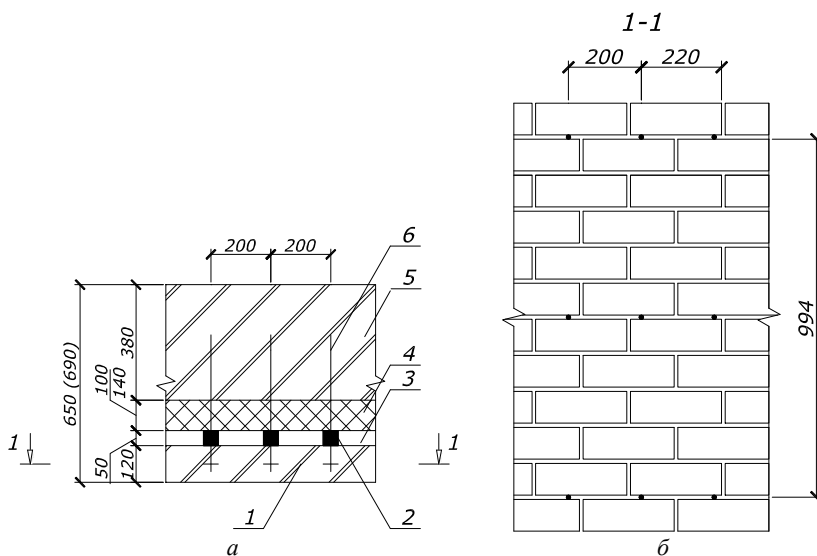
Конструктивное решение многослойной кирпичной кладки с плитным утеплителем:
